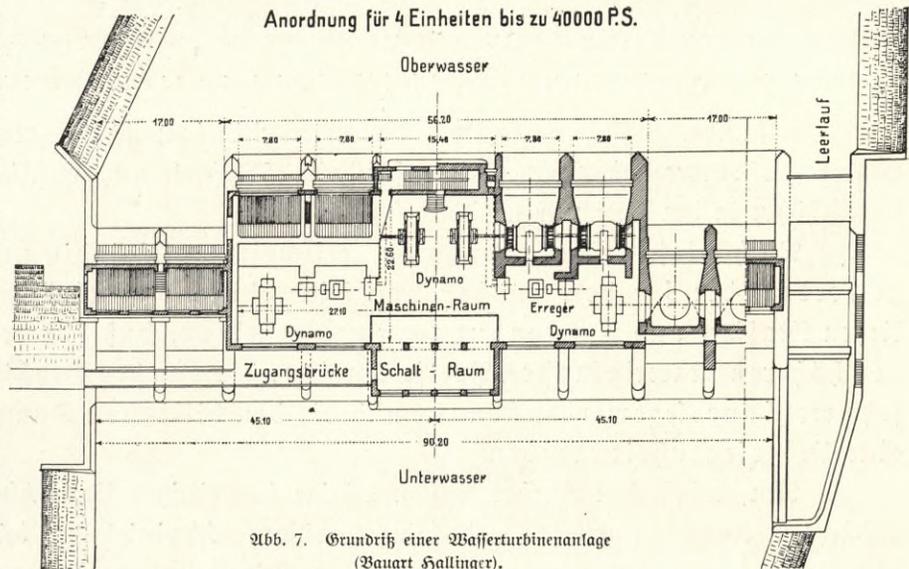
Grundriß einer Wasserturbinenanlage (Bauart Hallinger).
